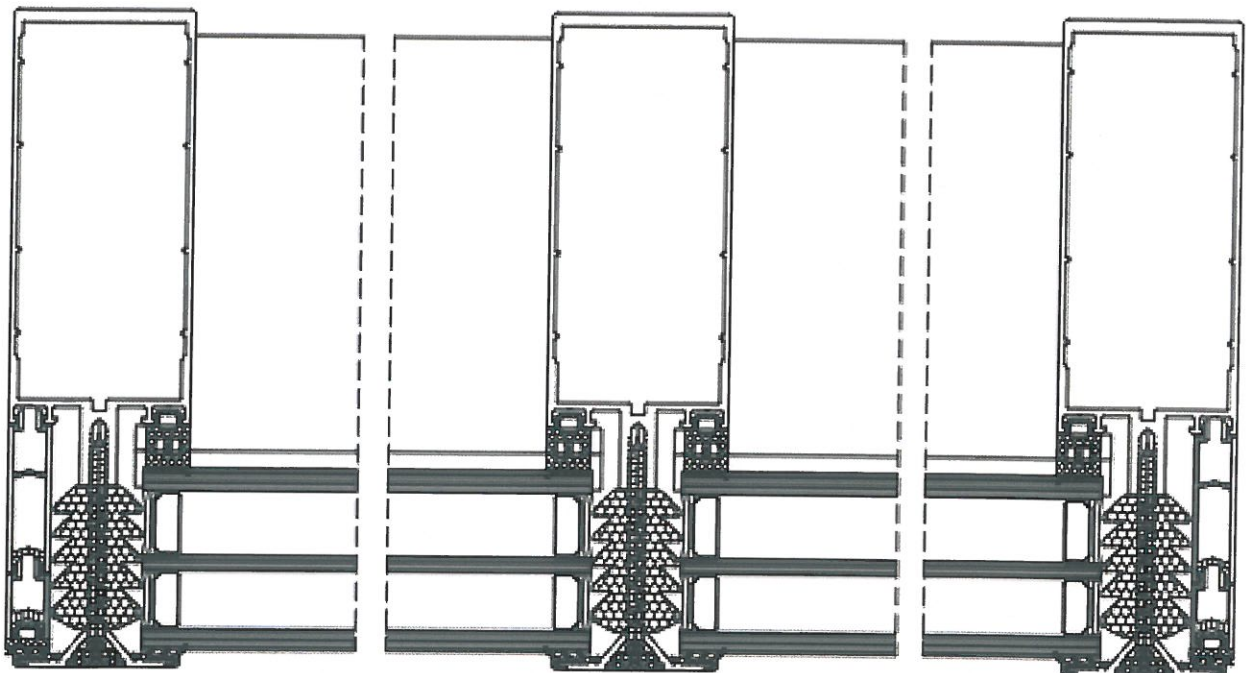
Горизонтальный разрез испытываемой конструкции.
